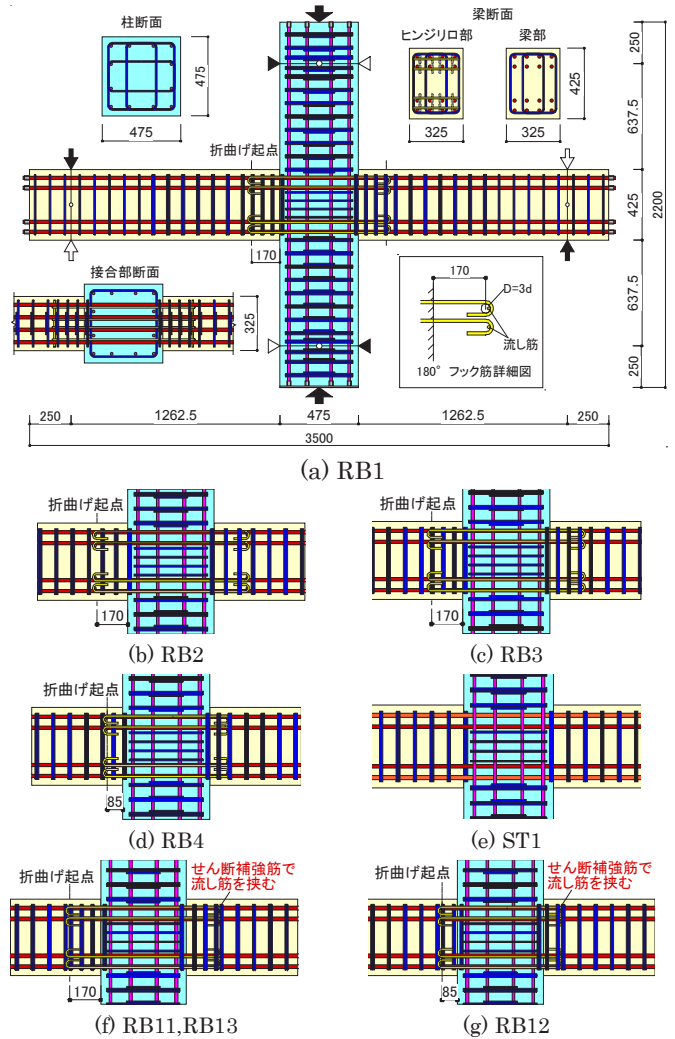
試験体配筋図 (Arrangement of the Specimens)
